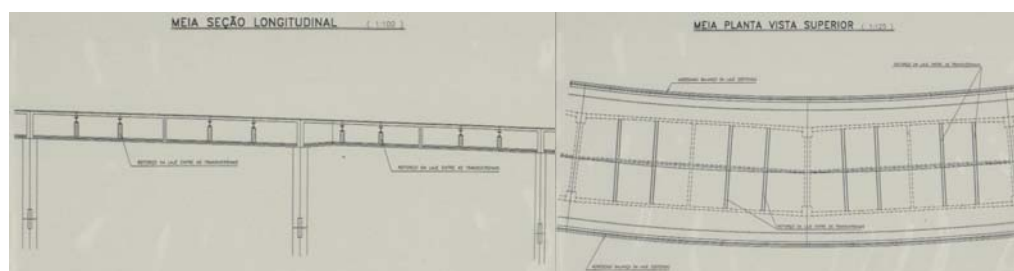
FOTO PROJETO DE VIGAS METÁLICAS EMPREGADAS
